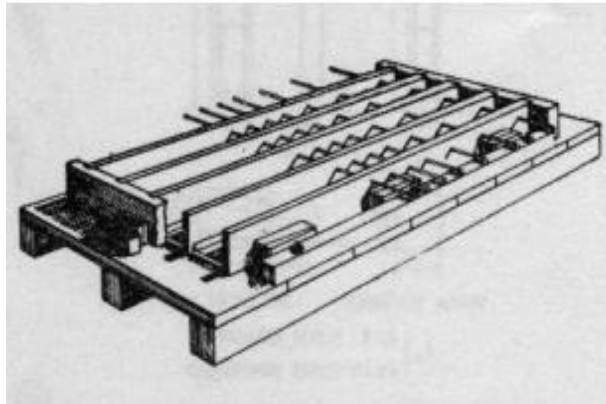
Moldes de madera para fabricar Postes de hormigón armado para alambrado.
